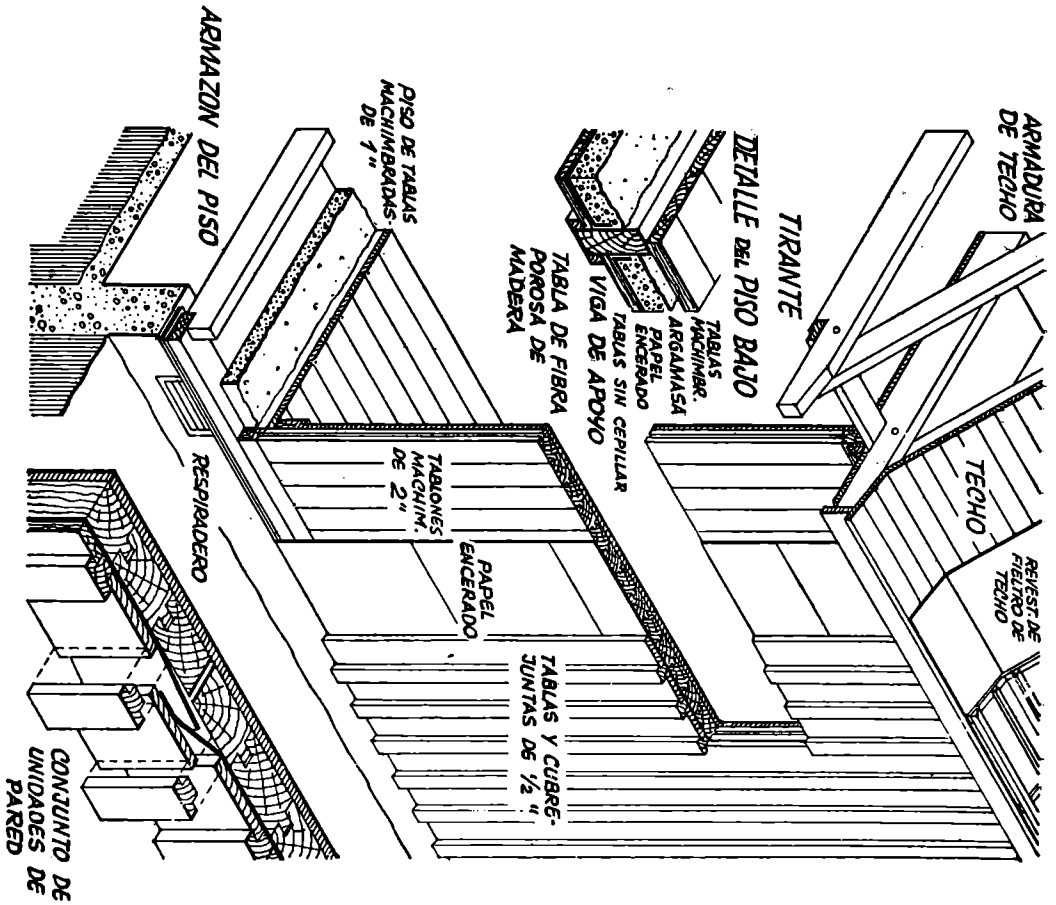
Más de doscientas casas, en su mayor parte de dos plantas, se han edificado en Inglaterra con el sistema Scano. Aunque, aparentemente, no son tan satisfactorias como sus similiares suecas y norteamericanas, el espesor de la carpintería las hace abrigadas y duraderas.
